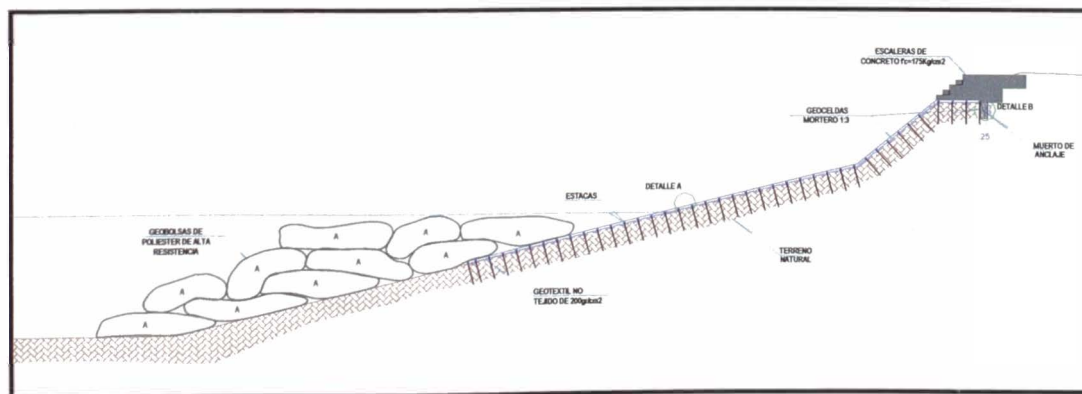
Sección Tipo II. Fuente, Elaboración Propia.
